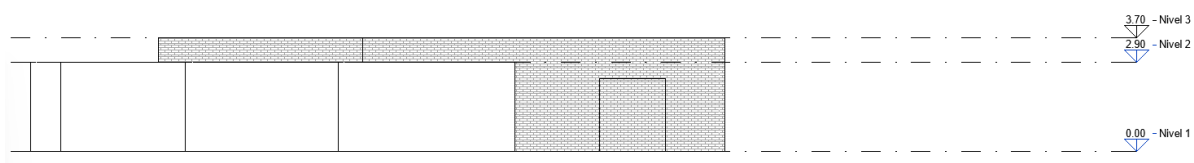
Alzado Sur modelo levantamiento con Dron LiDAR. Fuente: elaboración propia.
